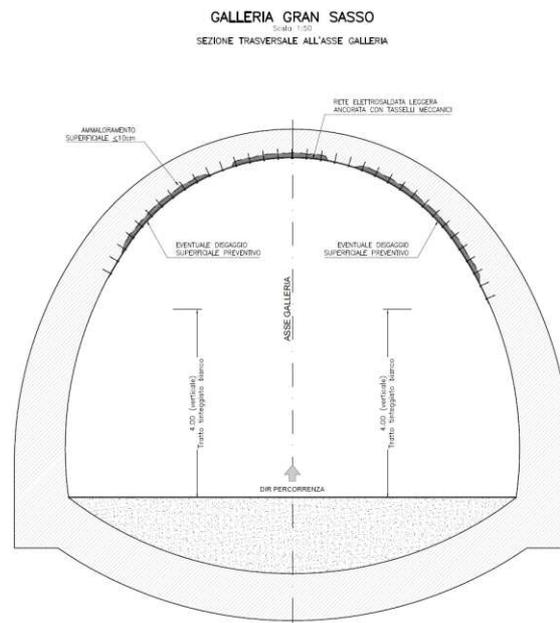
Rappresentazione tipologica su sezione trasversale galleria
